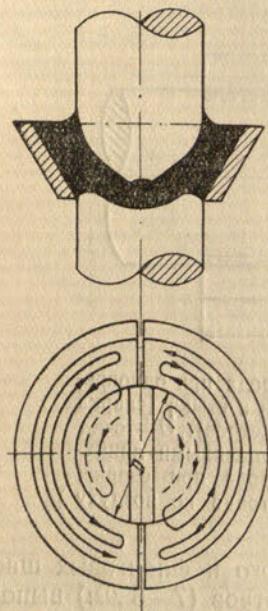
Продольное сечение вертикального стыка, выполненного ванной сваркой; внизу показана примерная схема полукольцевого движения электрода
